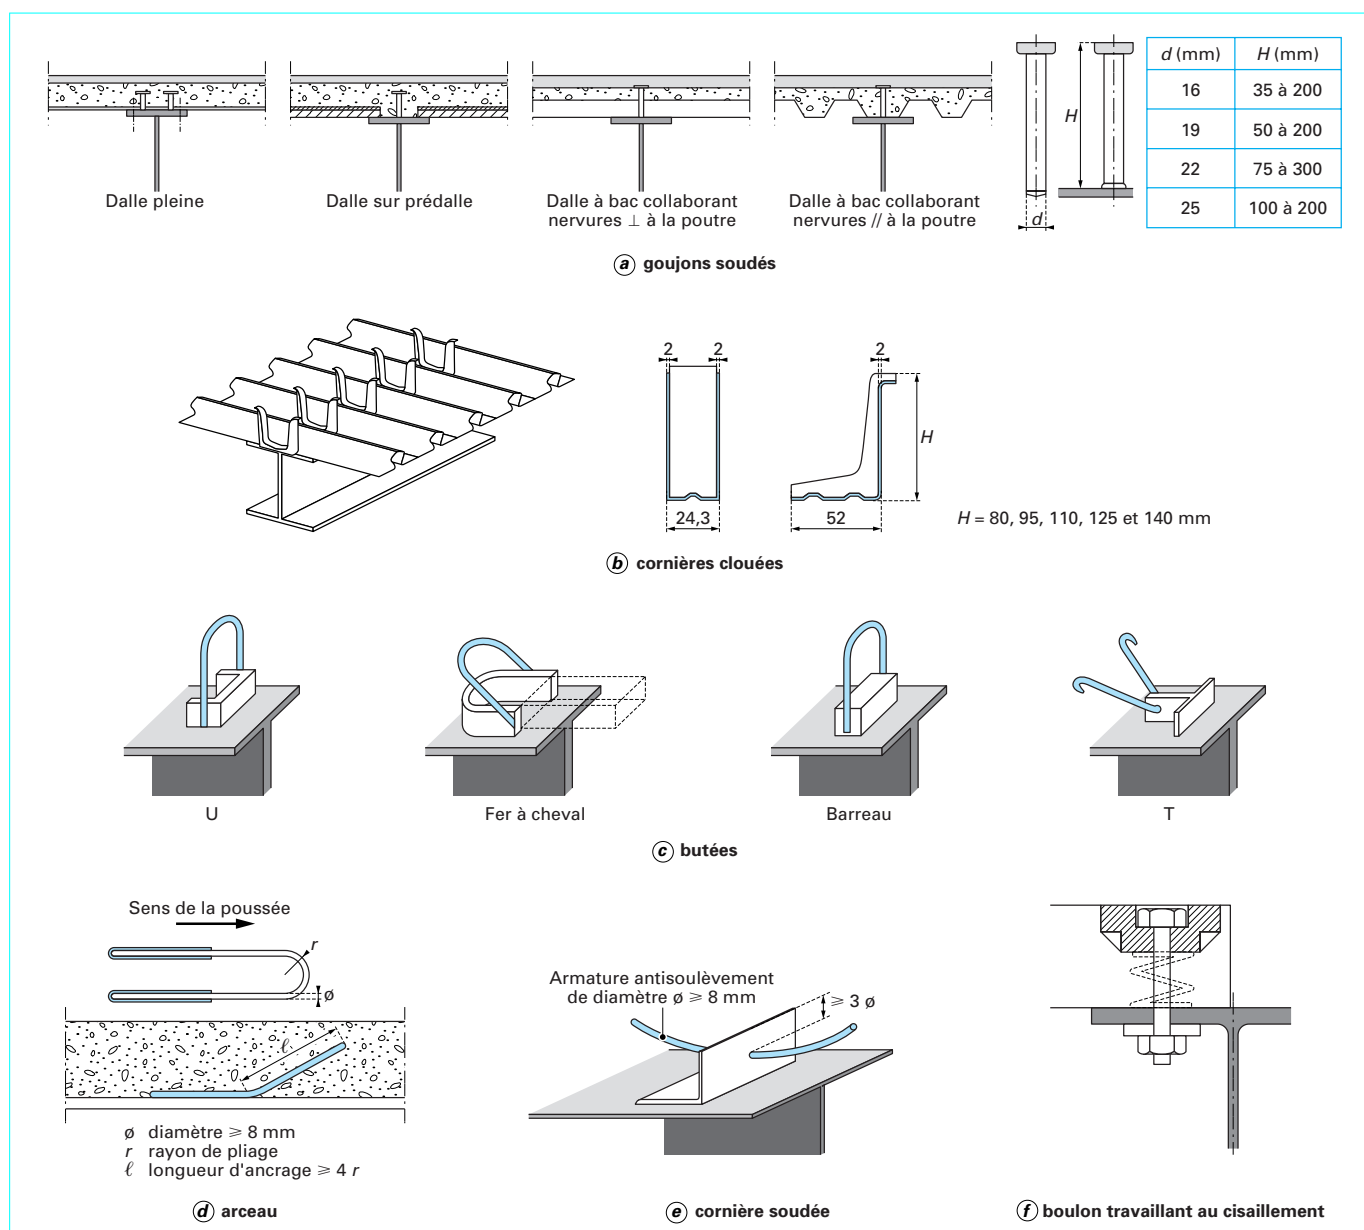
Différents types de connecteurs dans les planchers mixtes
